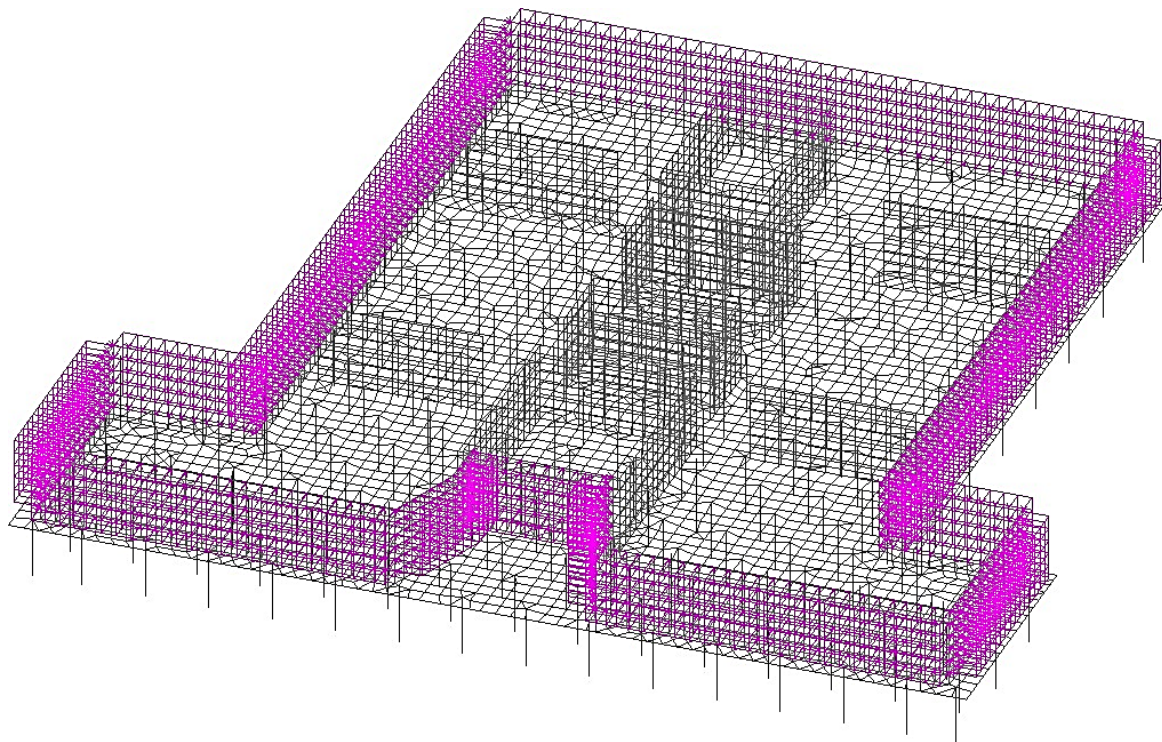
Схема навантаження ґрунту на стіни цокольних поверхів
